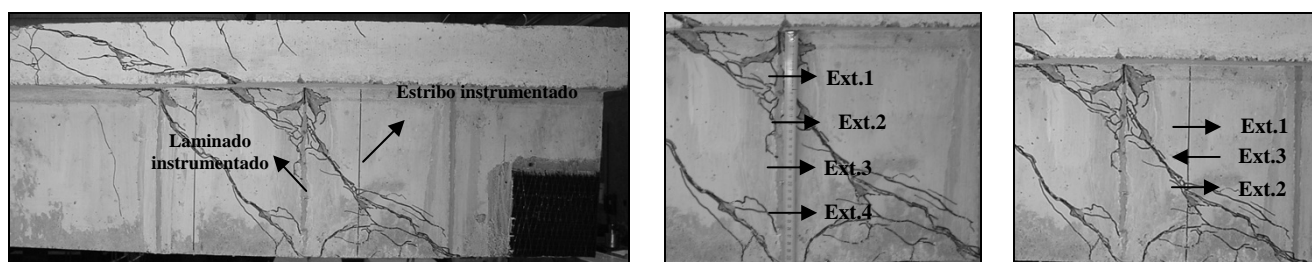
Localização dos extensómetros no laminado e estribo instrumentados da viga 2S-3LV-A.
